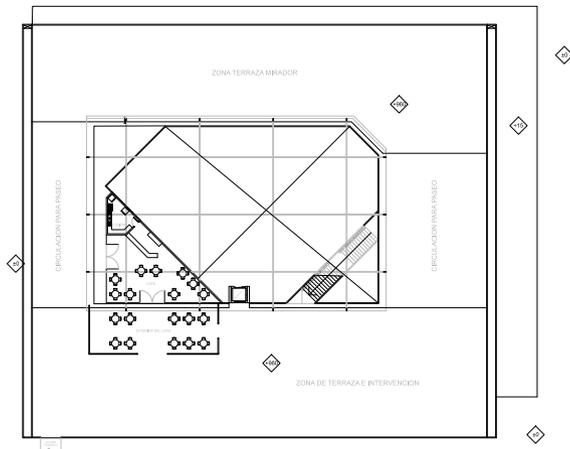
Planta nivel 2, Complejo Cultural Bellavista
